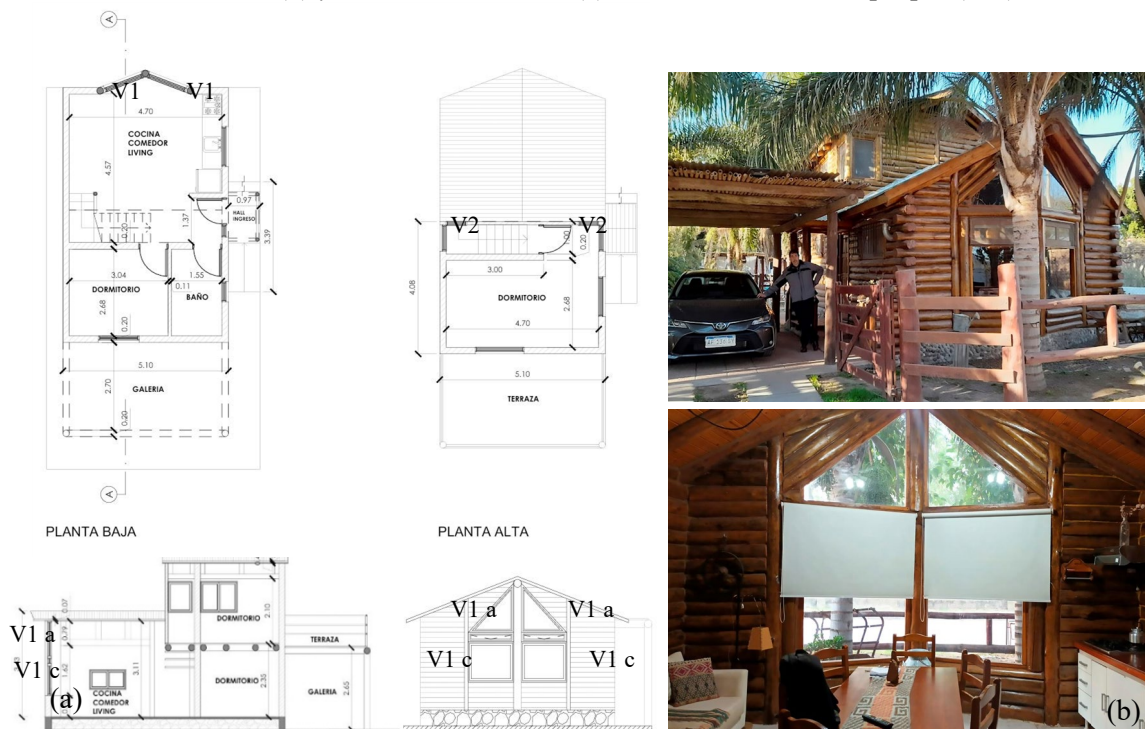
Planos (planta baja y alta), fachada y corte de CCB (a). Imágenes del exterior e interior de la cabaña (b). Fuente: E.P.
